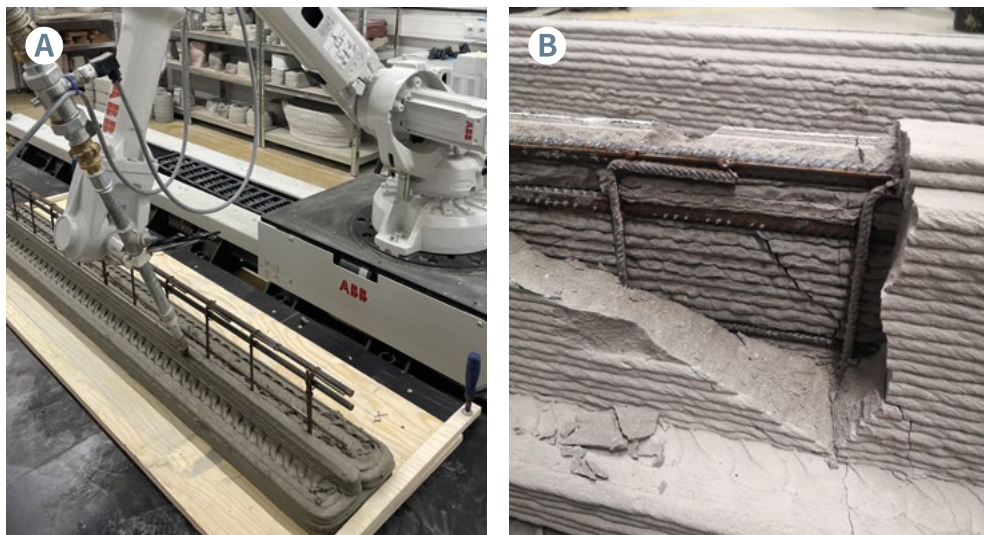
A) Herstellung des Trägers mittels 3D-Betondruck, B) Versagensbild nach Durchführung des Drei-Punkt-Biegeversuchs (eigene Darstellung)
